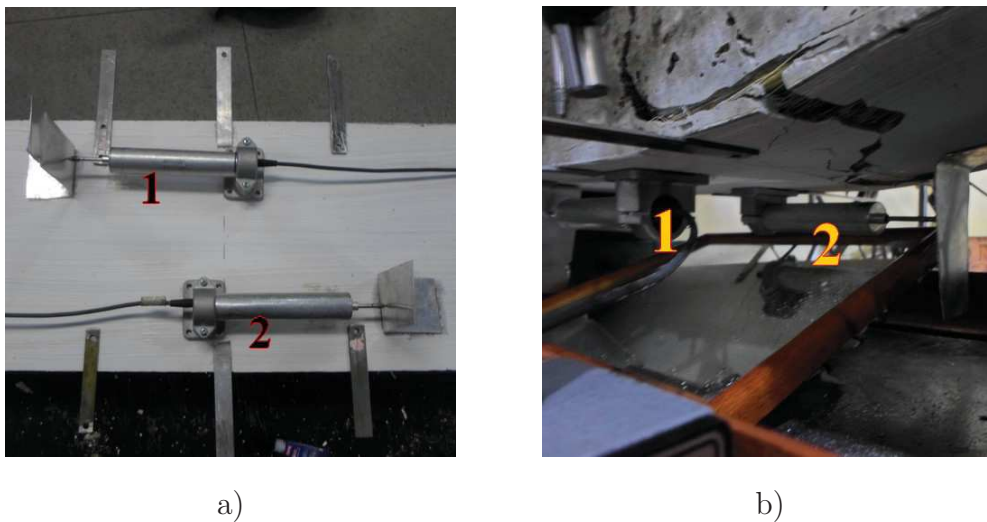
a) Fixação dos LVDTs b) LVDTs medindo as fissuras da face inferior
